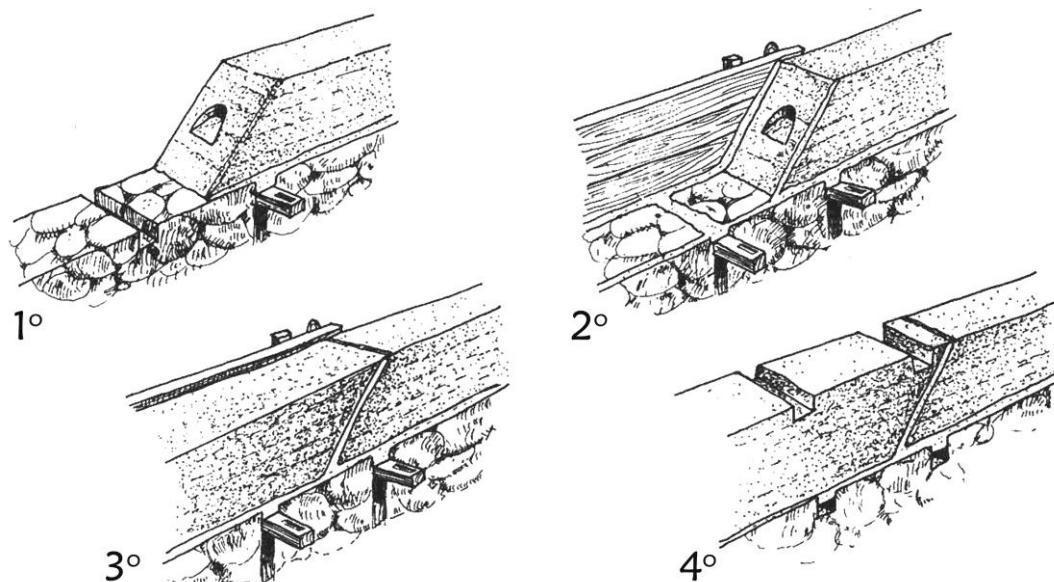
Técnica francesa del pisé. Aplicación de mortero de cal para evitar la retracción y aparición de fisuras en las juntas.
